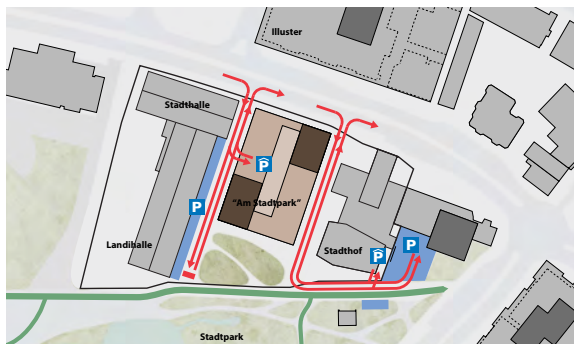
Erschliessung Phase 1 (Neubau «Am Stadtpark»)
